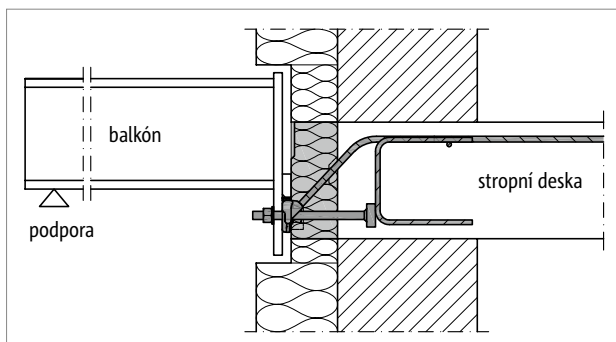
Schöck Isokorb® T typ SQP: Balkón se sloupovými podporami
